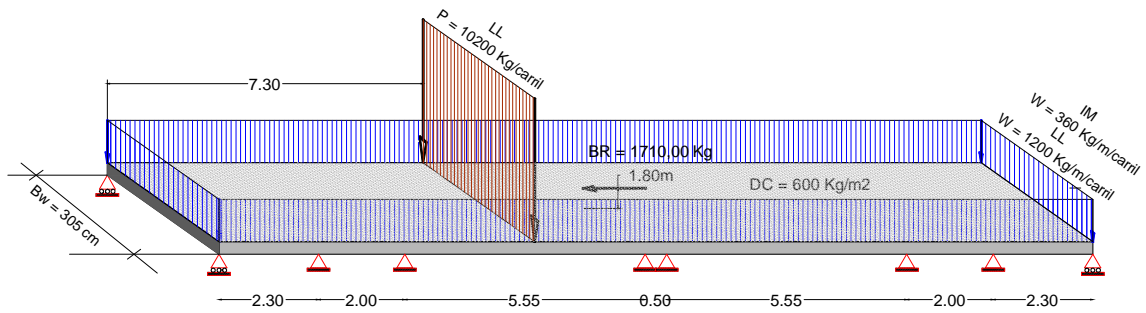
Cargas en la Franja de Tablero Longitudinal (Ancho =3.05m) AUTOR Pedro Hurtado L.
